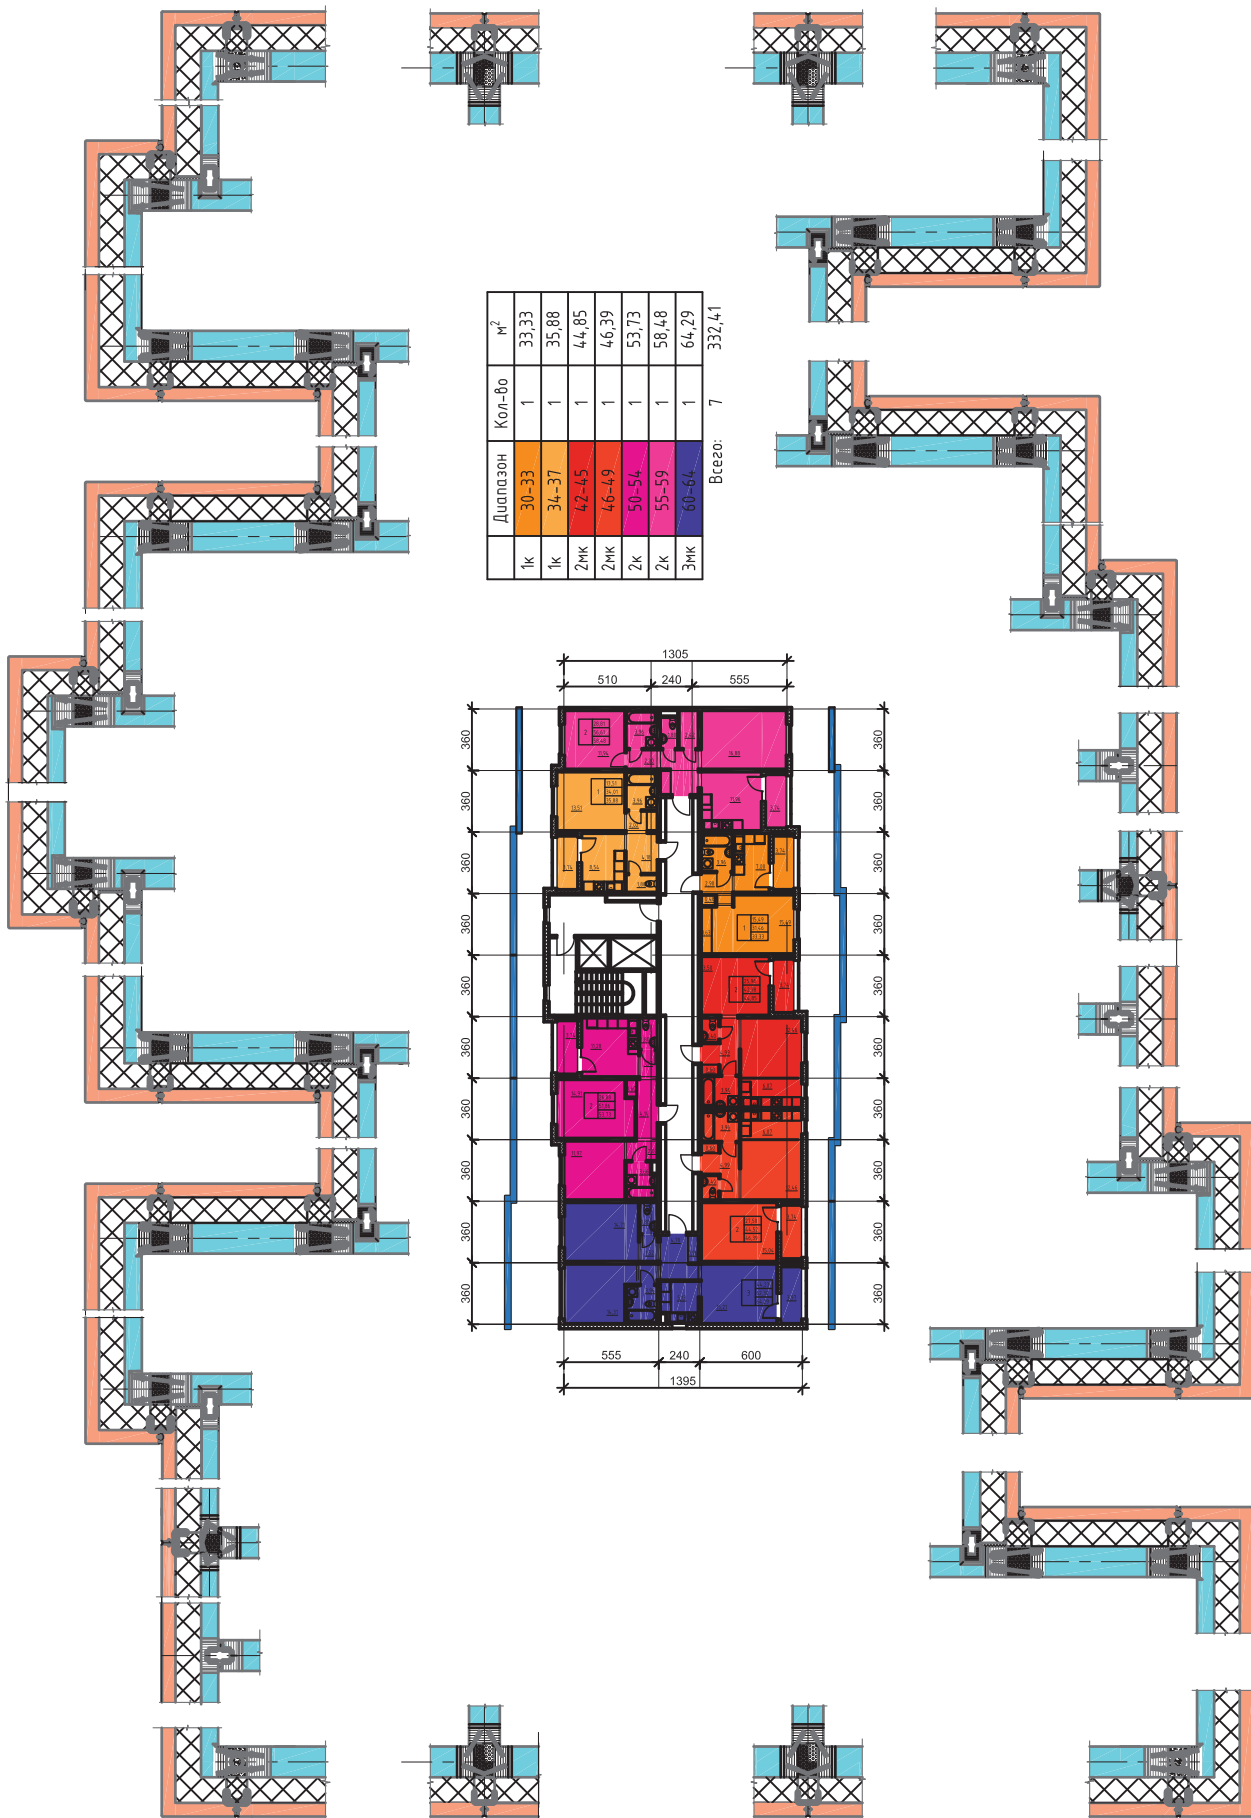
Пример плана секции на едином шаге панелей наружных стен
